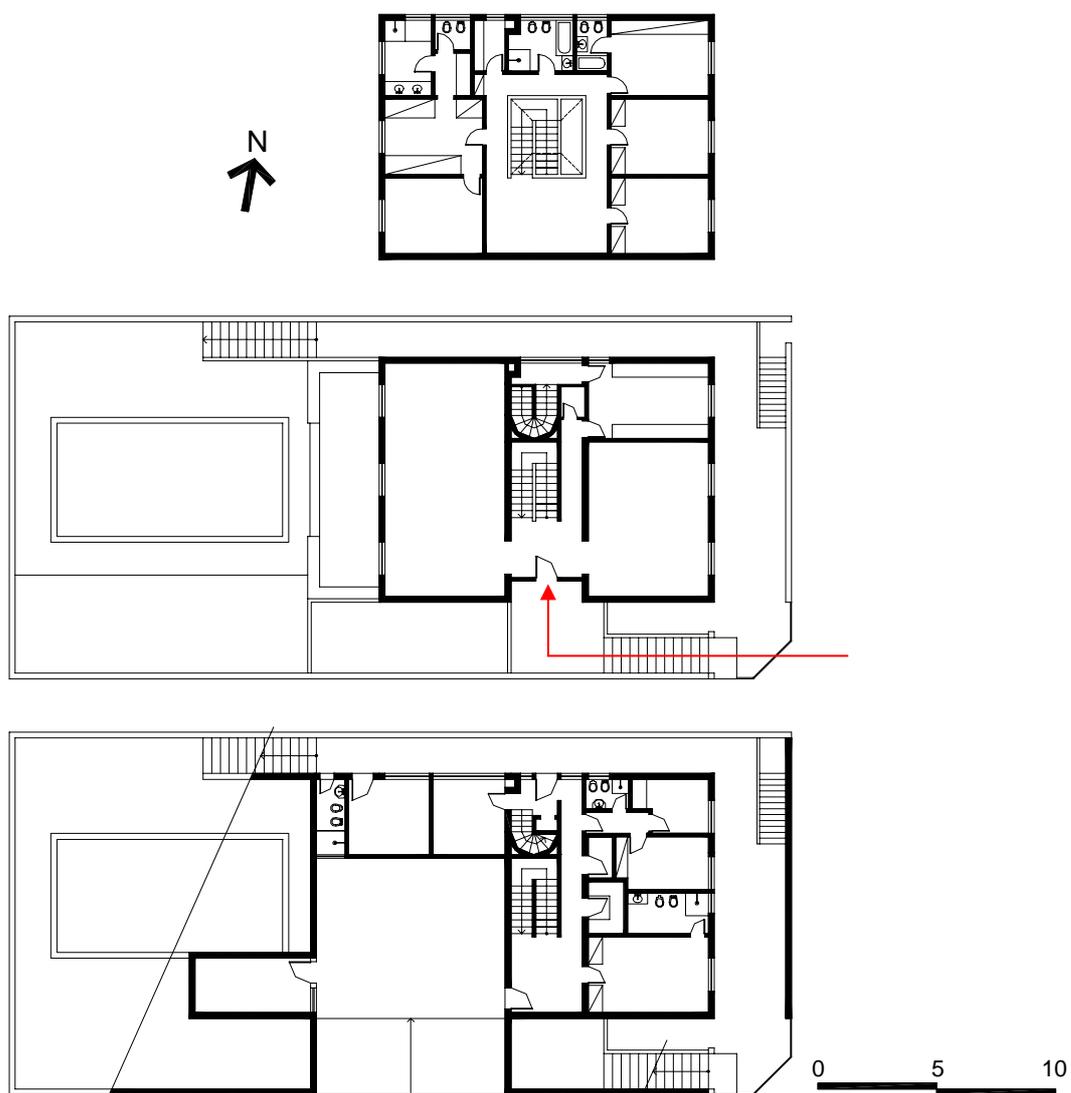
, 38 e 39: Plantas da Casa Magui Alvim, em Belo Horizonte. De baixo para cima: Pavimento inferior, pavimento térreo, e pavimento superior. (Desenhos da autora).
